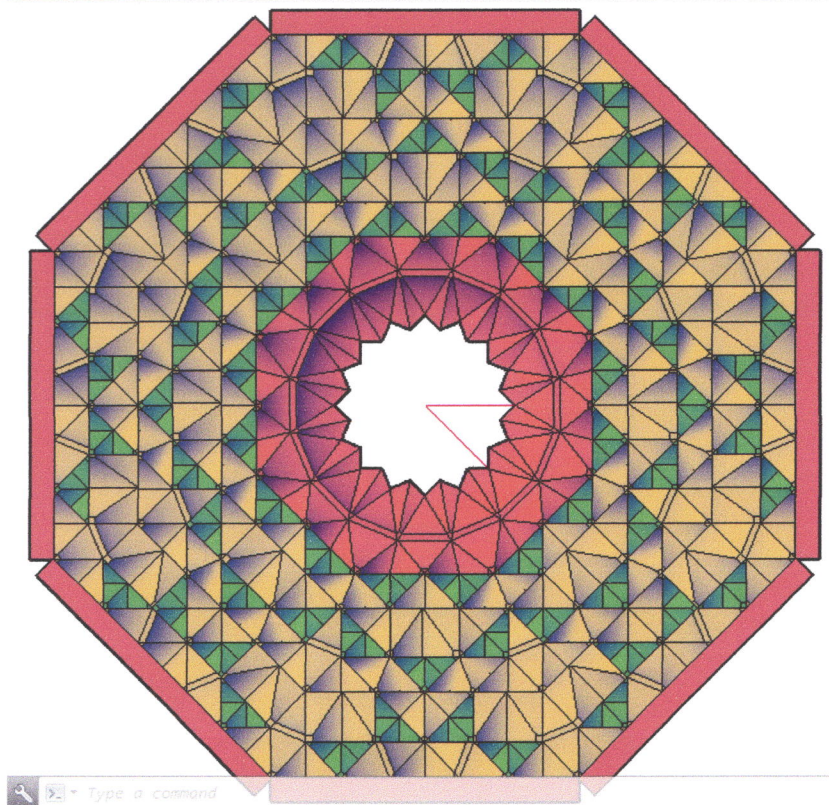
étape 04 du montage des pièces de Mouqarnas projection et 3d dessiné par l'auteur
